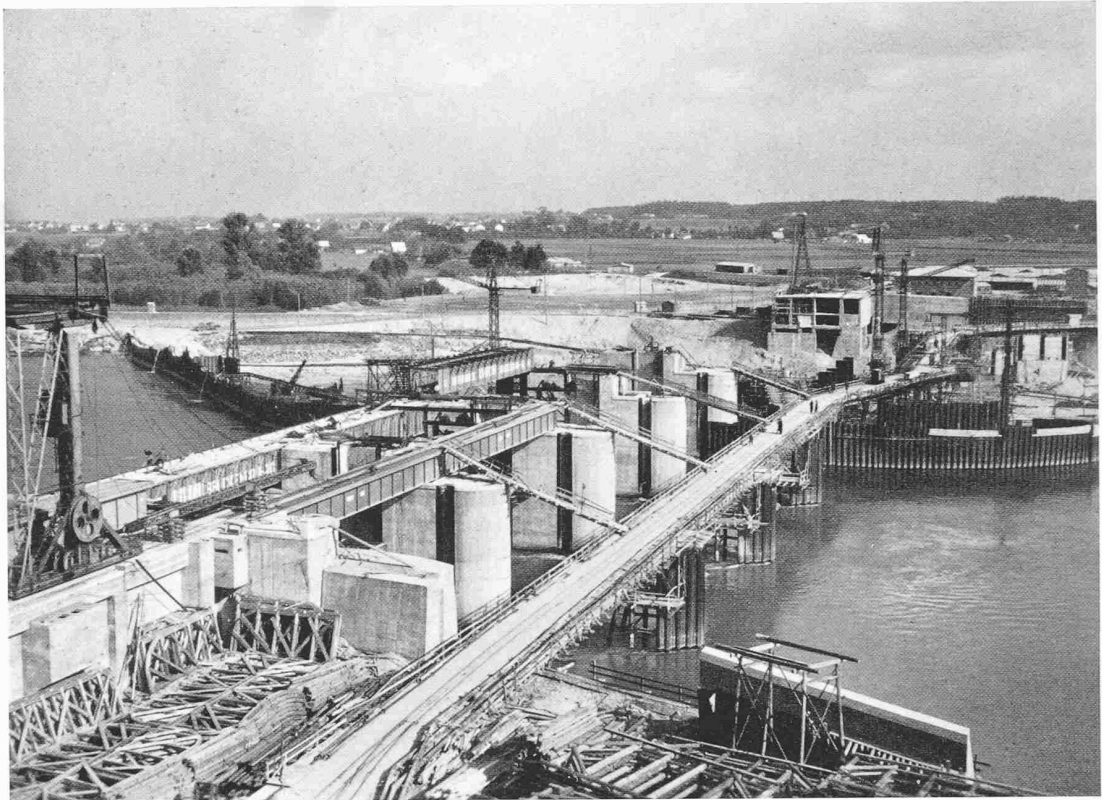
Blick vom linken Ufer über die fertigen Wehrpfeiler gegen die Krafthausbaugrube
